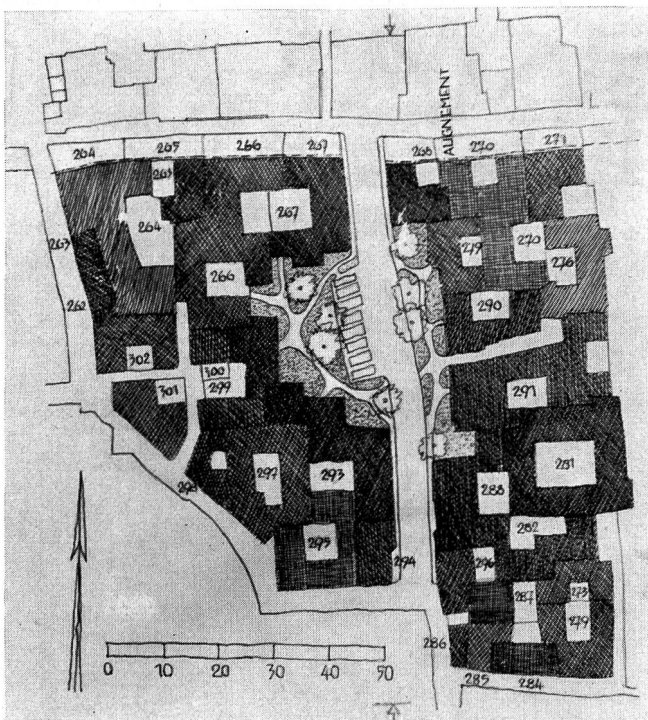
Développement de l'aménagement de la fig. 10 en reconstruisant sur les mêmes parcelles des maisons arabes.
